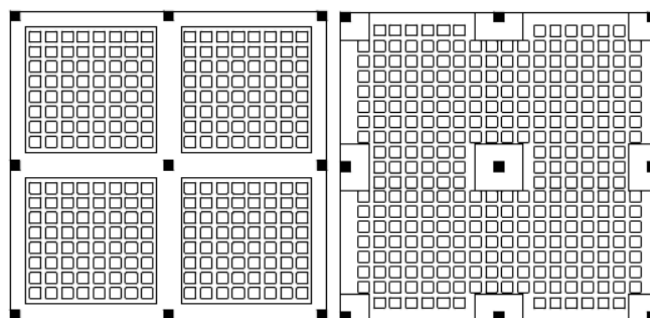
Laje nervurada com vigas-faixa e laje nervurada com engrossamento na região dos pilares, respectivamente. (ESTECHE, 2008)
